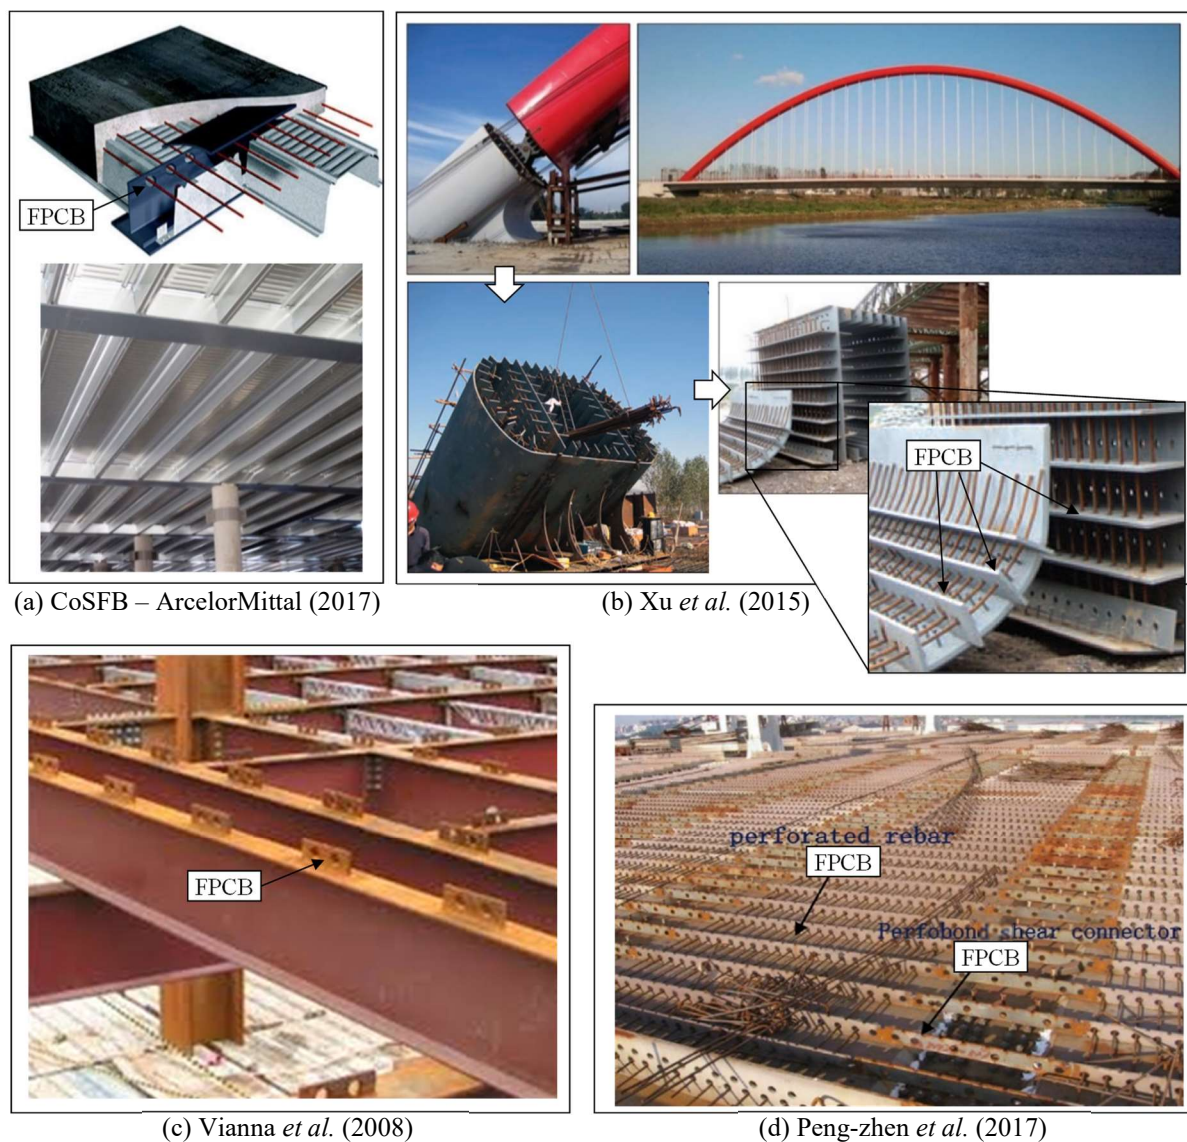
Exemplos de aplicação dos conectores FPCB: (a) viga mista tipo *slim-floor*; (b) bloco misto de transição entre elemento de aço (arco da ponte) e elemento de concreto (fundação); (c) conector Perfobond em sua concepção original para vigas mistas convencionais; (d) tabuleiro misto enrijecido de uma ponte.
